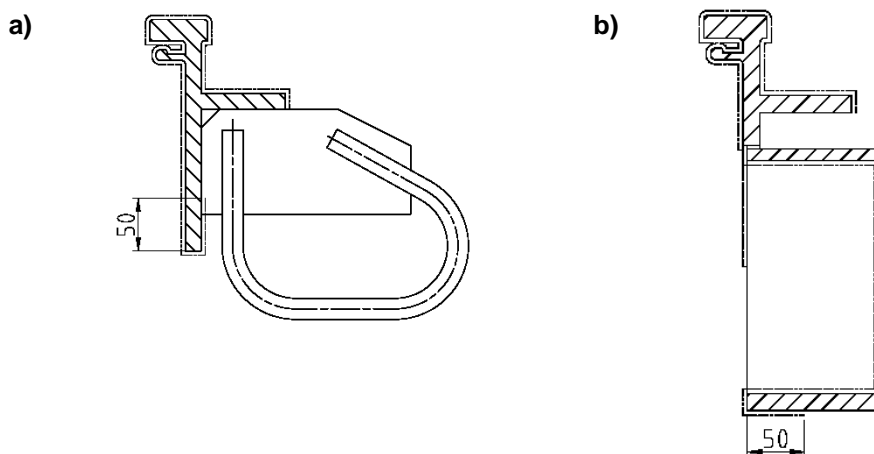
Beschichtung der betonberührenden Bauteile: a) Randprofil, b) Traversenkasten
